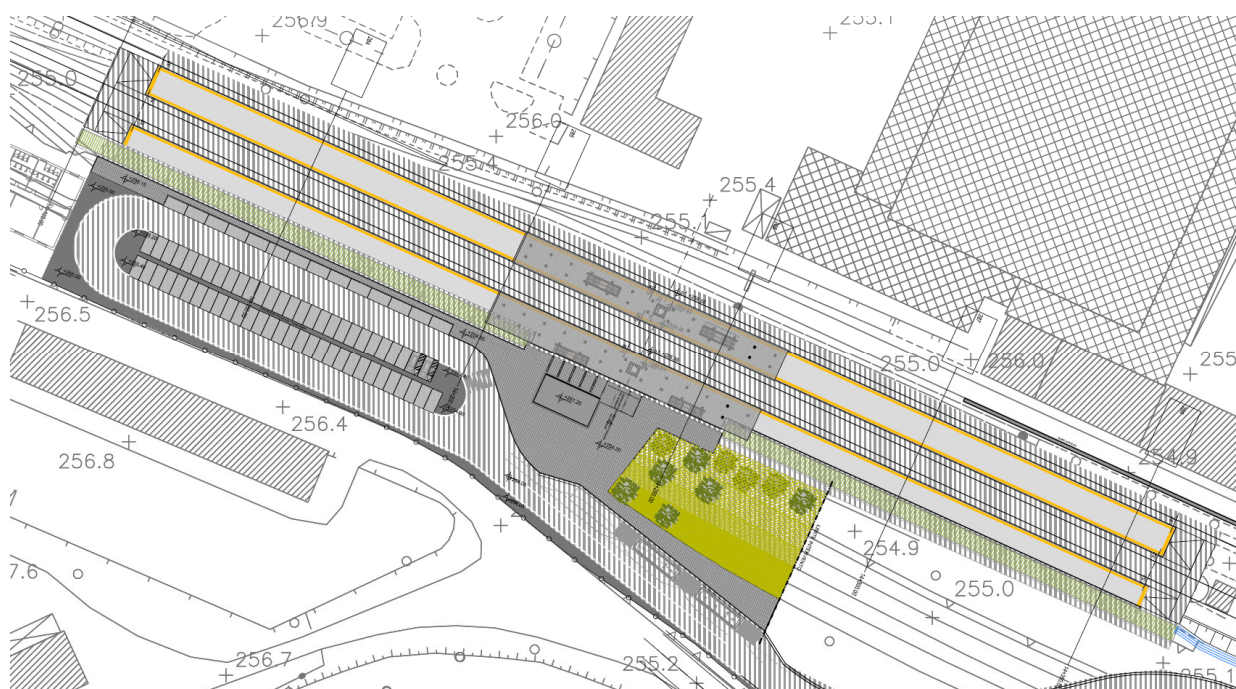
Pianta quota banchina stazione di Enna (Rif.)
